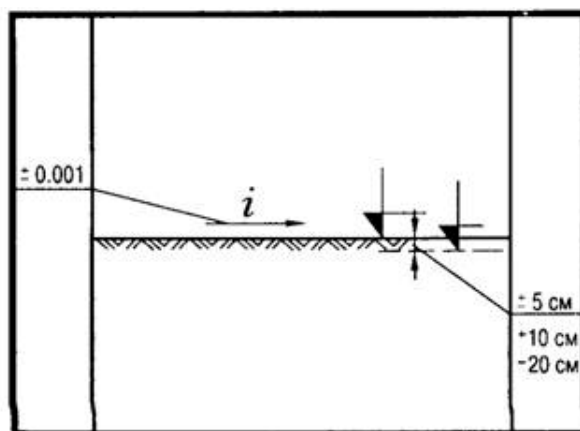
Допускаемые отклонения вертикальной планировки поверхности
